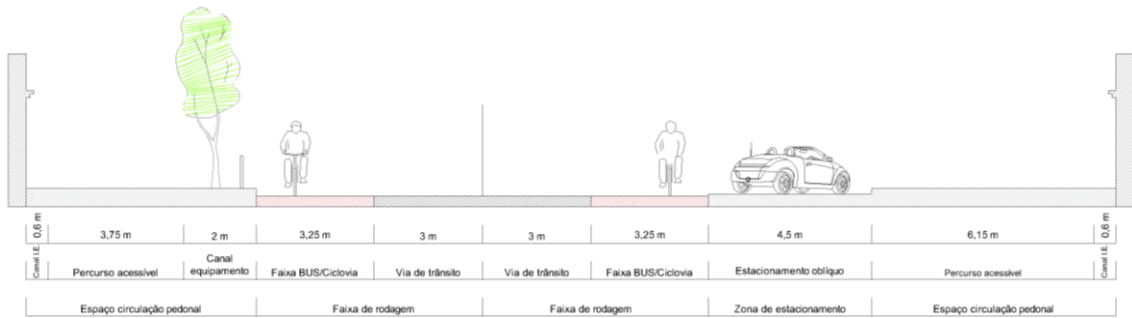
SECÇÃO PROPOSTA K-K'
